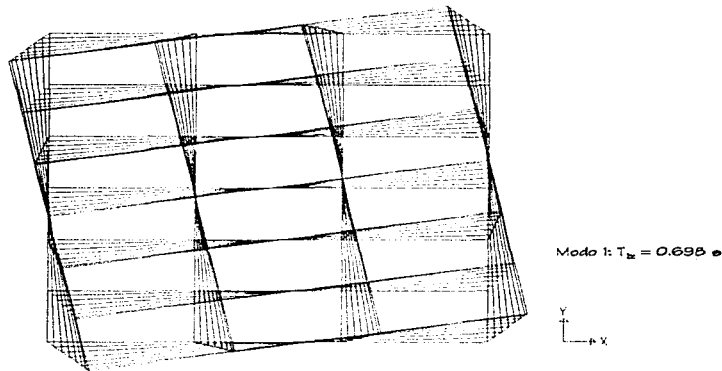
Vista en planta del modo fundamental de vibración en dirección "Z", estructura de 7 niveles diseñada en zona III
